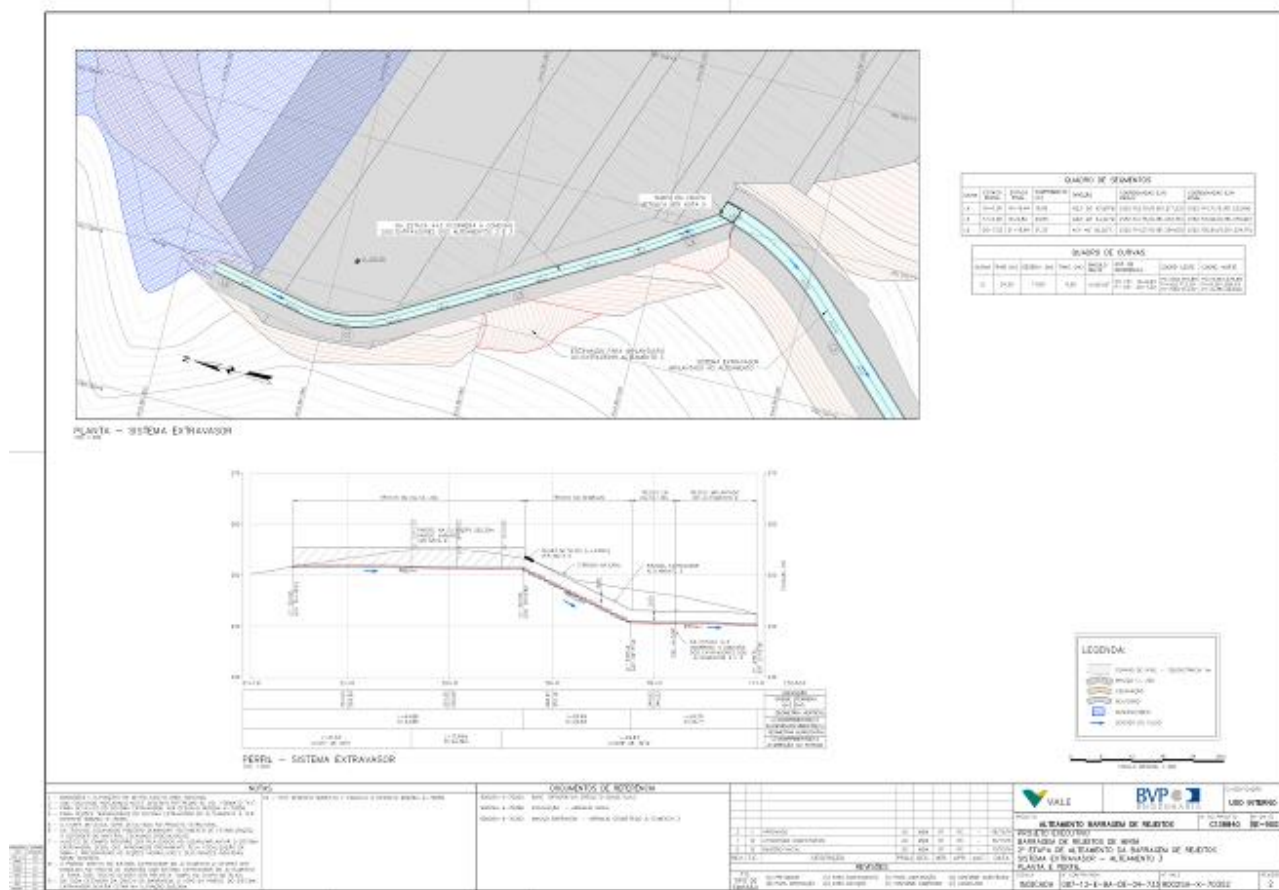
Planta e perfil longitudinal do extravasor da elevação 245,0 m.
